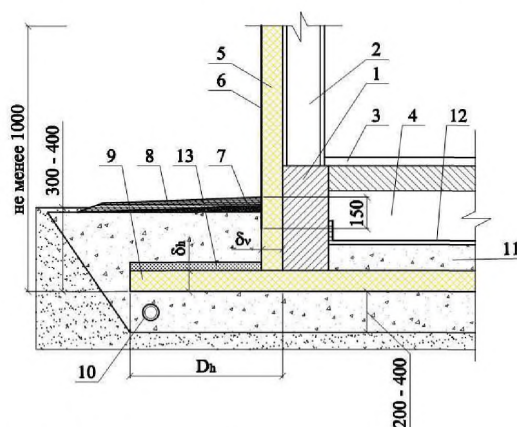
Схема укладки и параметры теплоизоляции URSA XPS в фундаментах зданий с неветилируемым подпольем и переменным режимом эксплуатации (отапливаемое — неотапливаемое)
